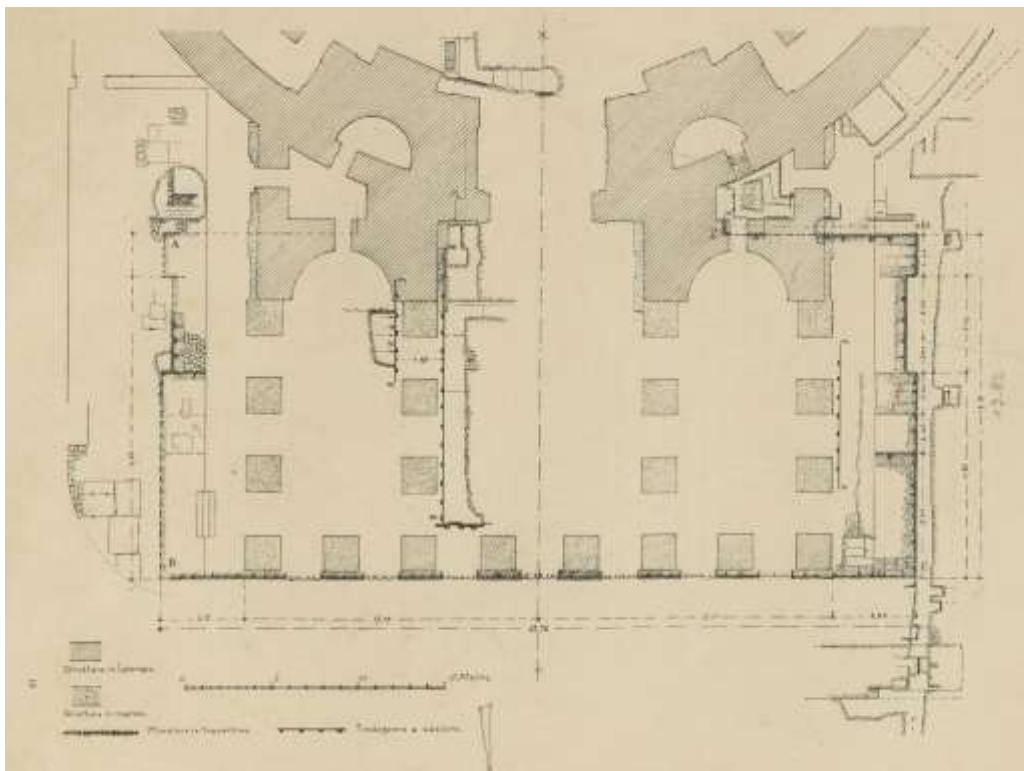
Pianta degli scavi condotti nel portico del Pantheon - Pier Olinto Armanini 1892.
